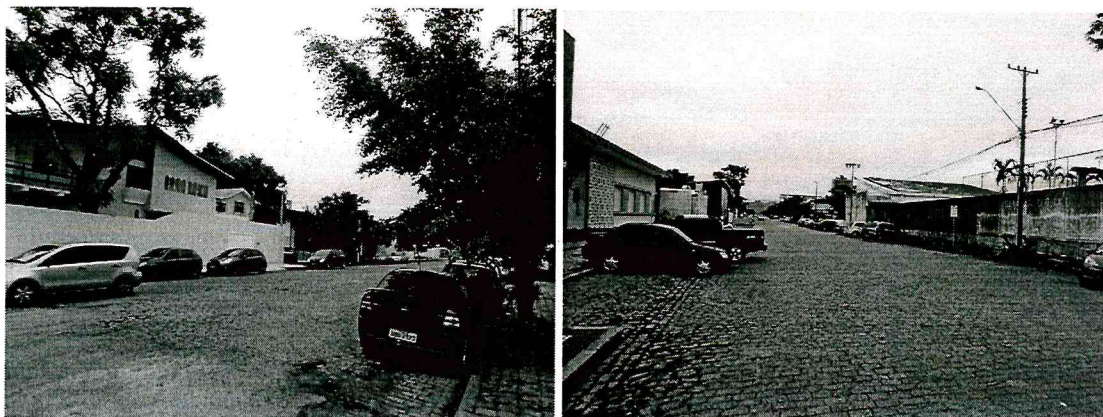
Acesso Rua Baronesa do Cerro Azul.
